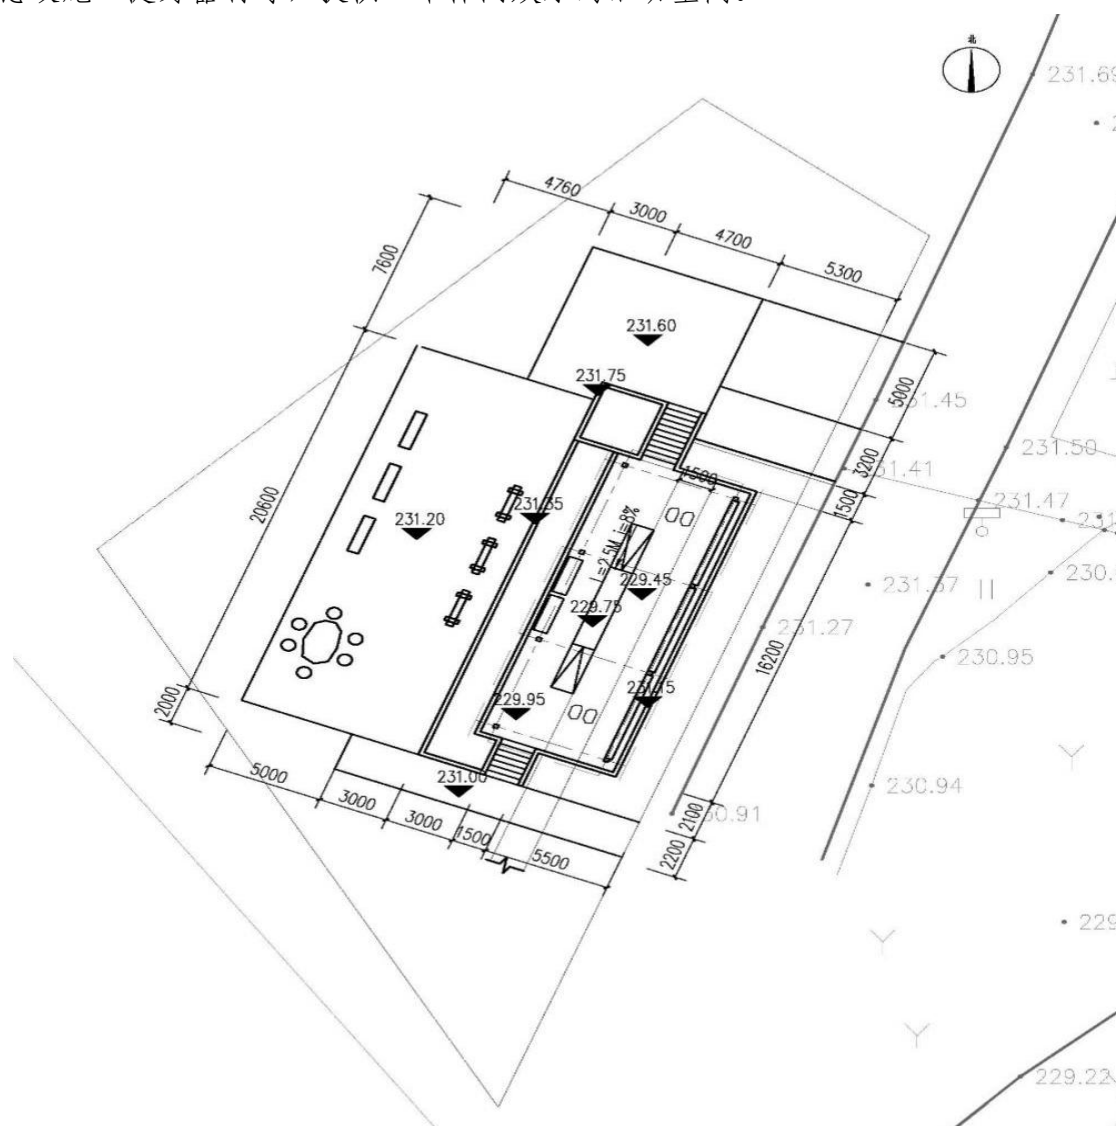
交通桥 1#洗衣长廊节点平面图
